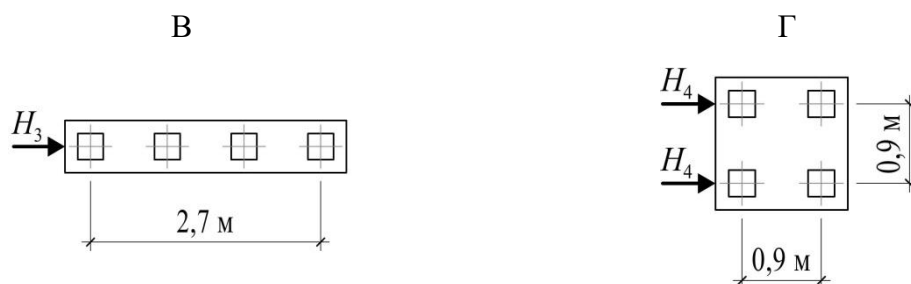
Схемы горизонтально нагруженных фундаментов: В – ряд из 4 свай; Г – группа из 4 свай
